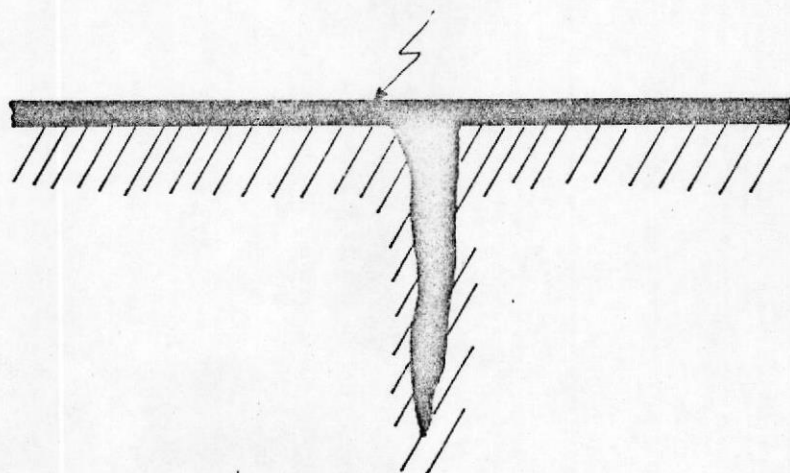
CAPILARIDAD EN UNA FISURA (4)
